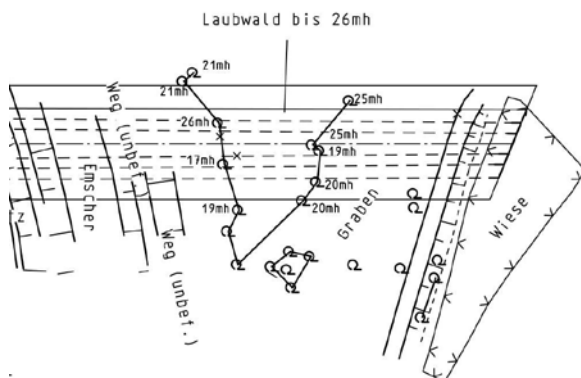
Lageplanausschnitt Vermessung zwischen P1 und Mast Nr. 48
